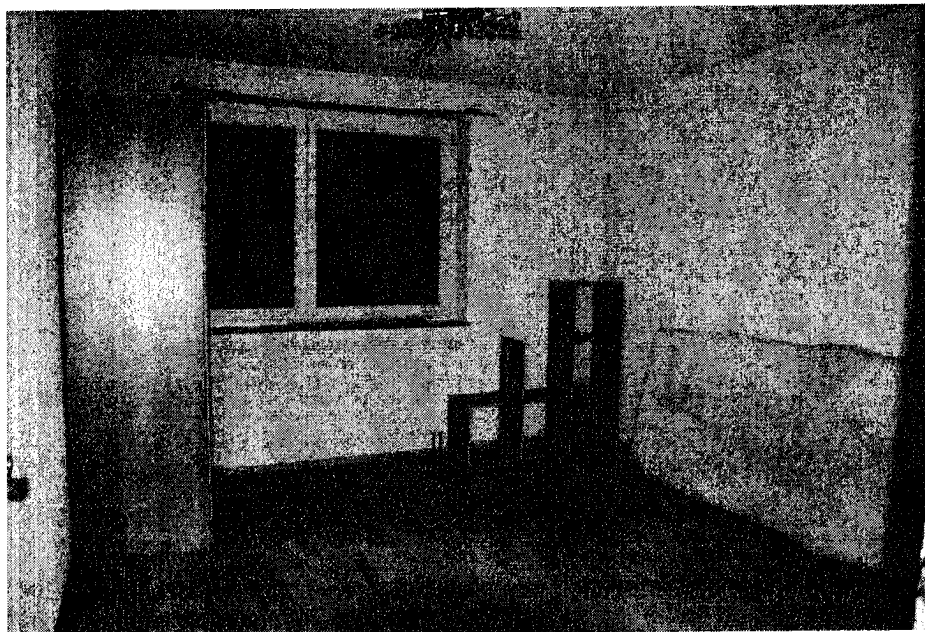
Erdgeschoss Eltern-Schlafzimmer, defekter Rollladengurt
